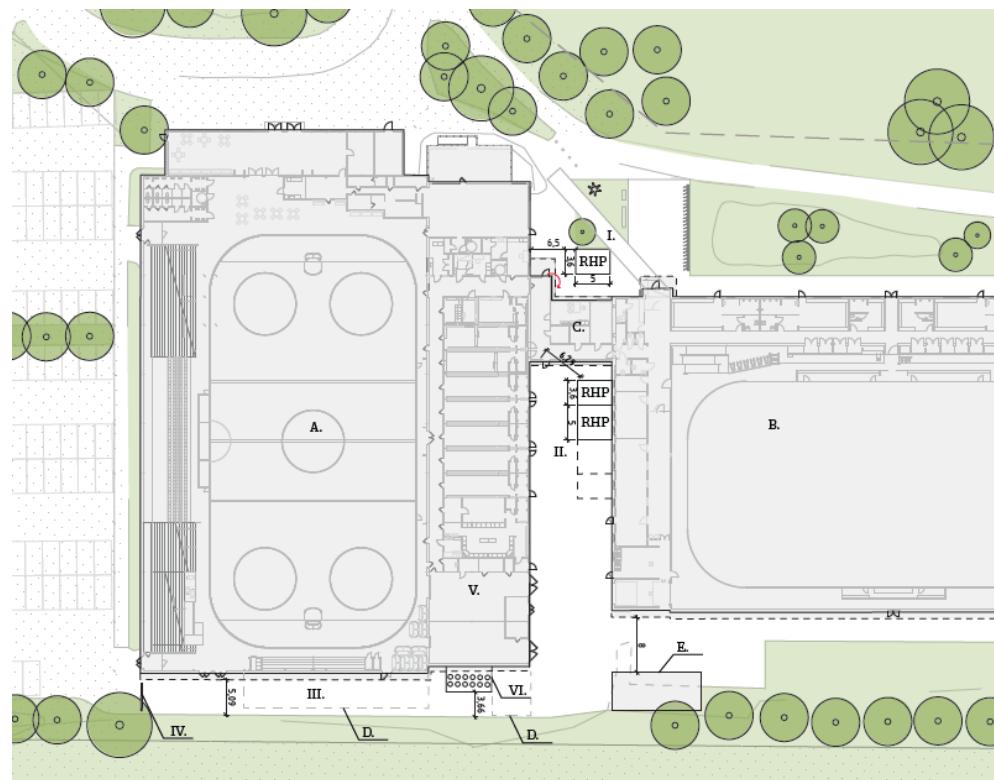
Inzoomning på länkbyggnad mellan Bahcohallen och Sandbrohallen.
